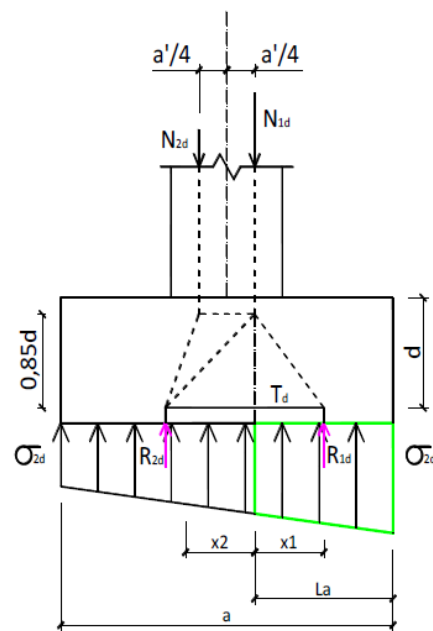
Modelo de Biela y tirante para zapata rígida
